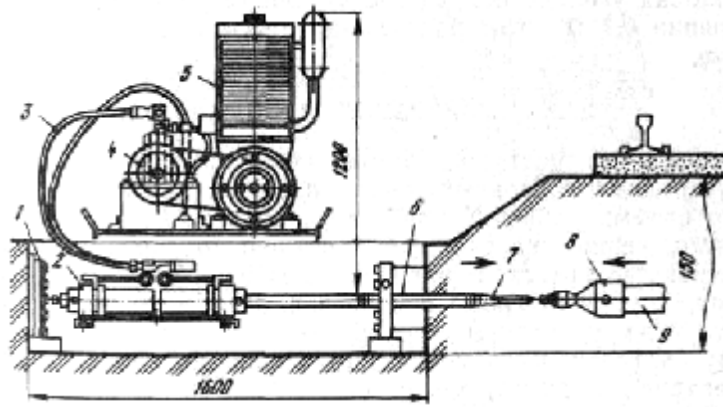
Прокладка трубопровода гидравлическим буром: 1 — опорная плата; 2 — гидравлический пресс; 3 — шланги; 4 — насос высокого давления; 5 — силовая установка; 6 — стальная штанга; 7 — наконечник; 8 — расширитель; 9 — труба.
